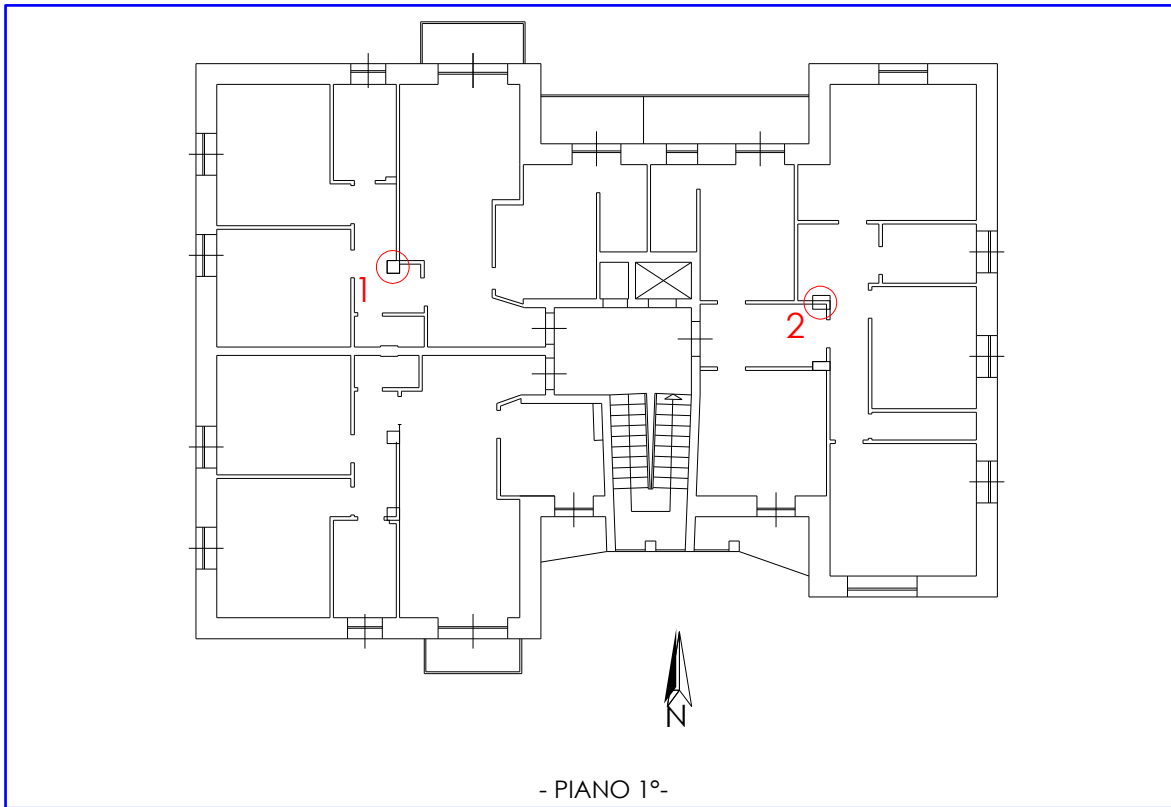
Planimetria del piano primo (L1) con l'ubicazione delle zone esaminate
